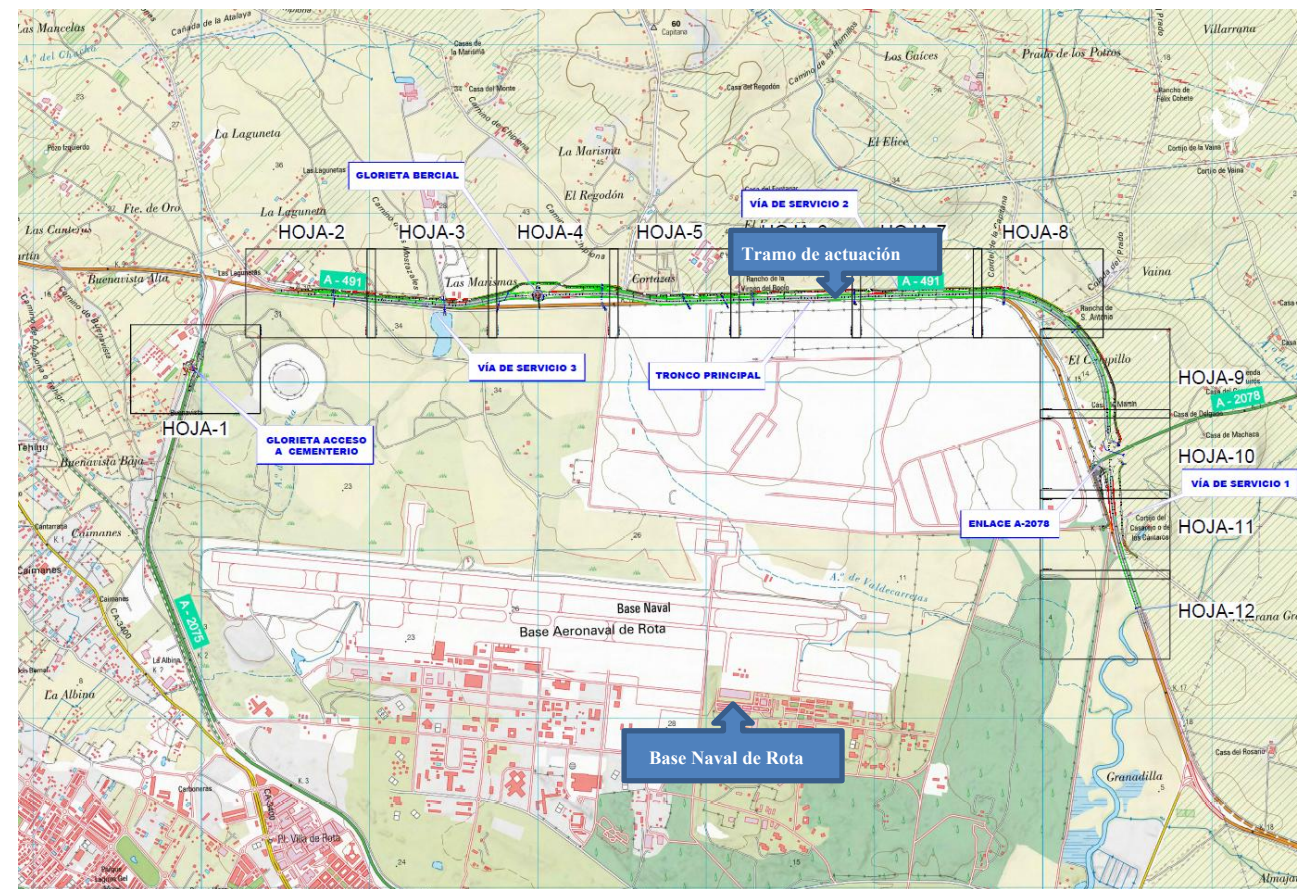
Planta general del ámbito de actuación y entorno proyecto inicial.
